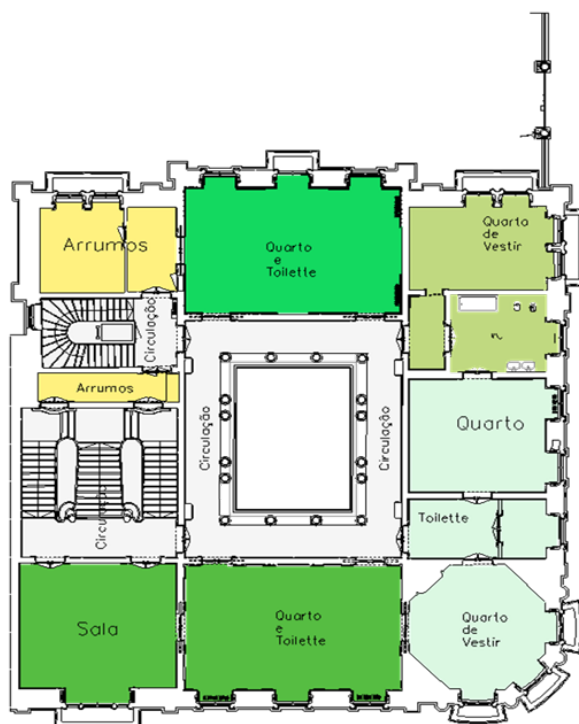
P R C - Planta piso 0 - Levantamento.
